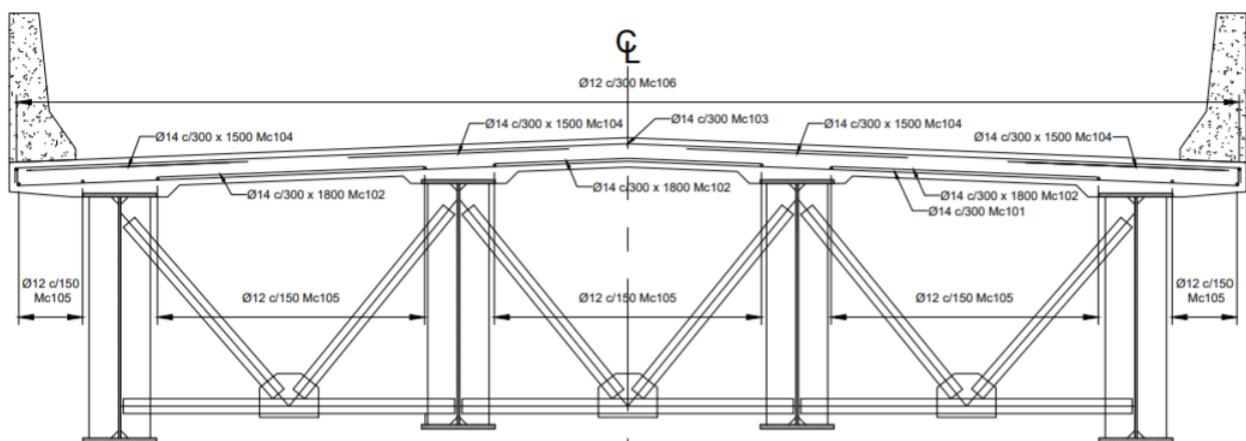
Sección transversal de la losa [Elaboración propia]
